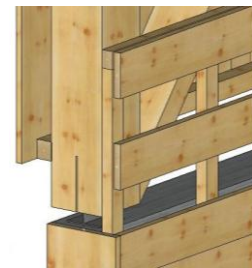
Détail de l'assemblage du poteau sur le mur béton banché
